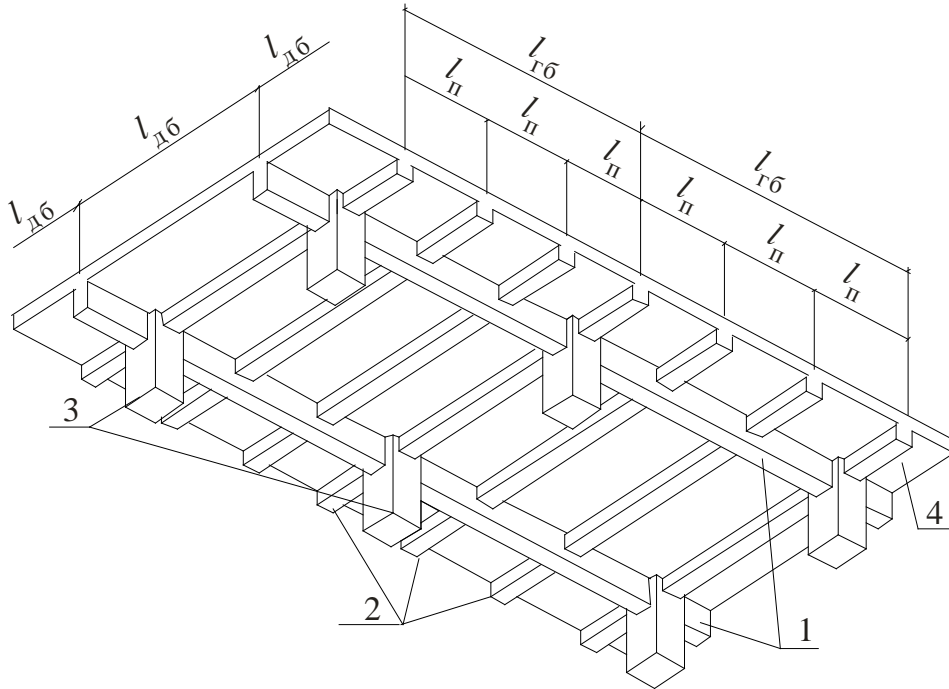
Монолітне ребристе перекриття з балочними плитами: 1 – головні балки; 2 – другорядні балки; 3 – колони; 4 – плита
